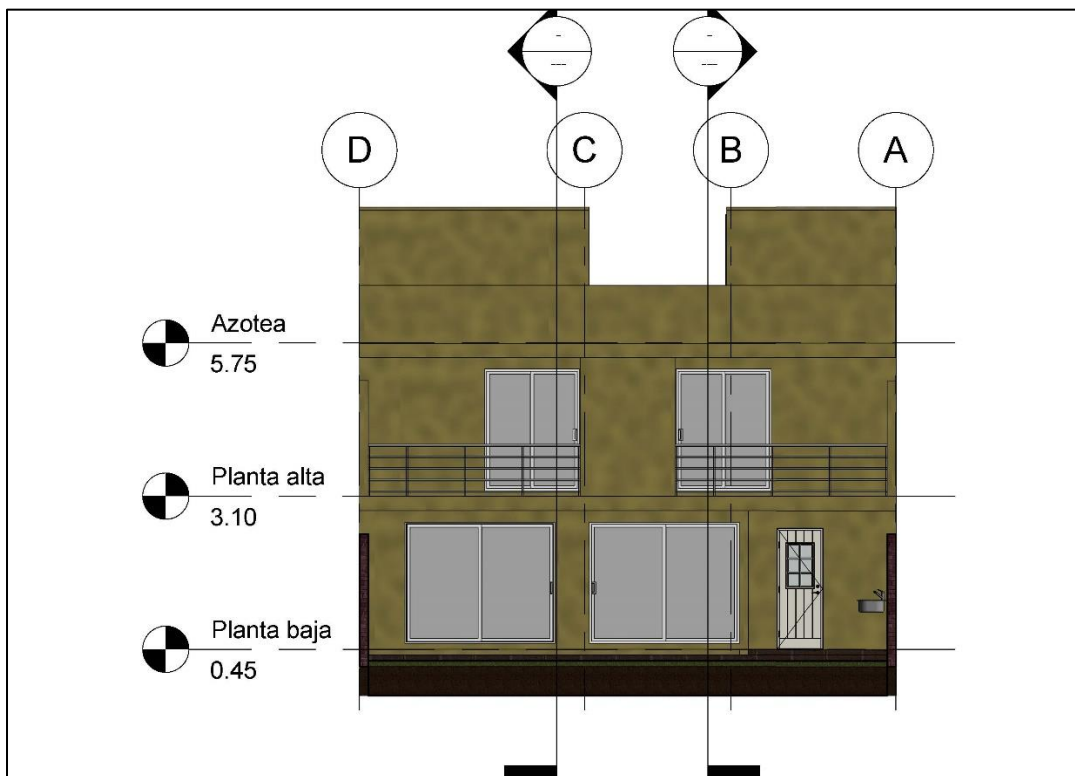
Plano de vivienda no sustentable: fachada Sur. Fuente: autoría propia
